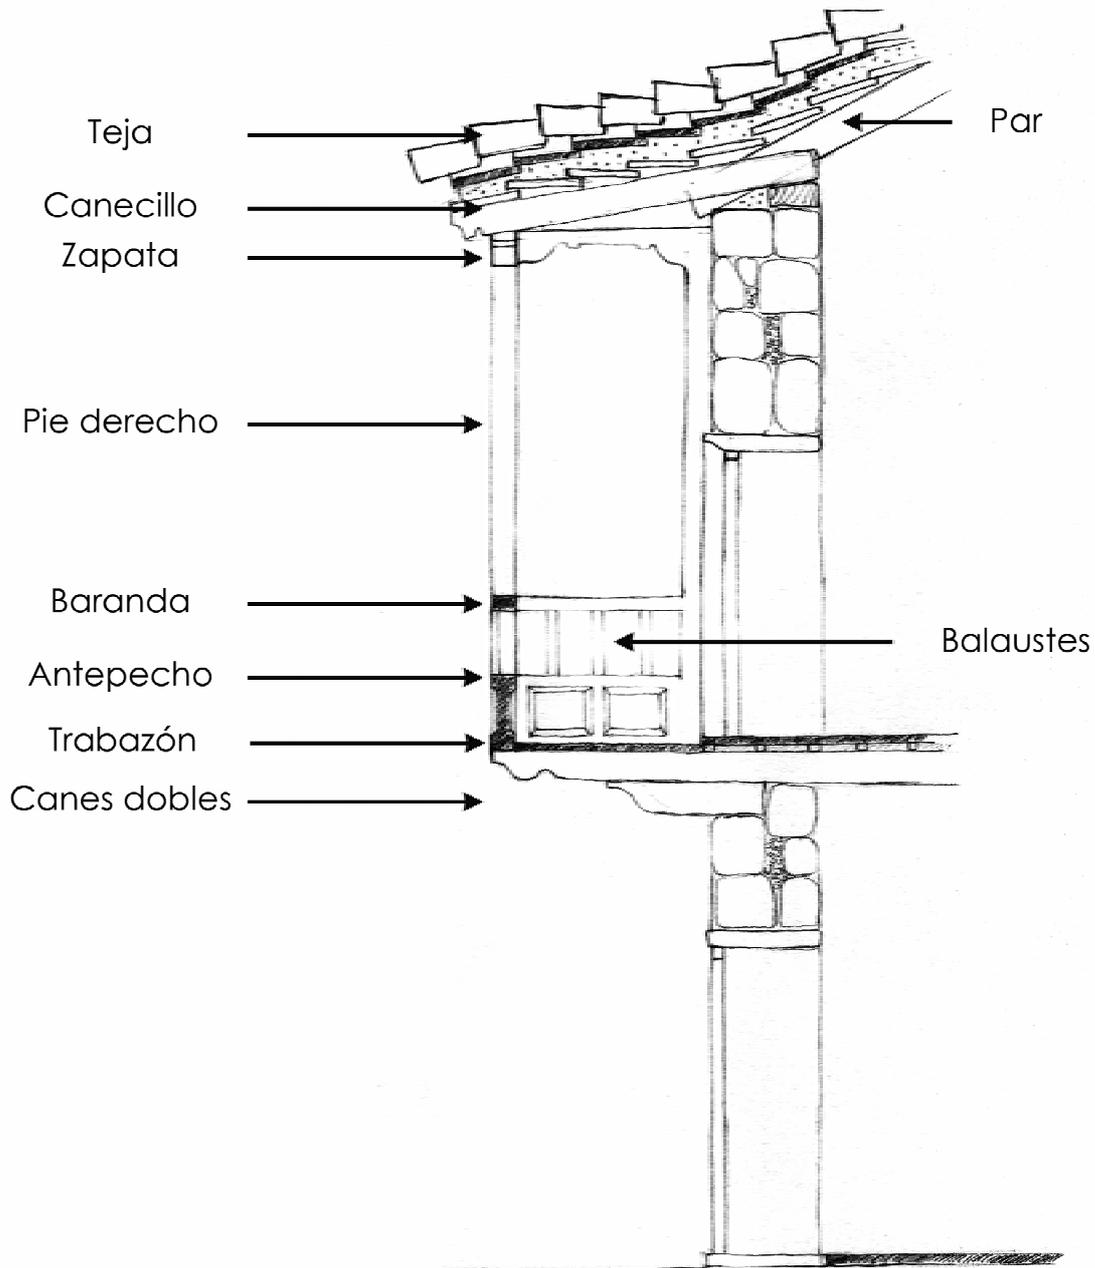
Sección constructiva de un balcón volado. Elaboración propia.
